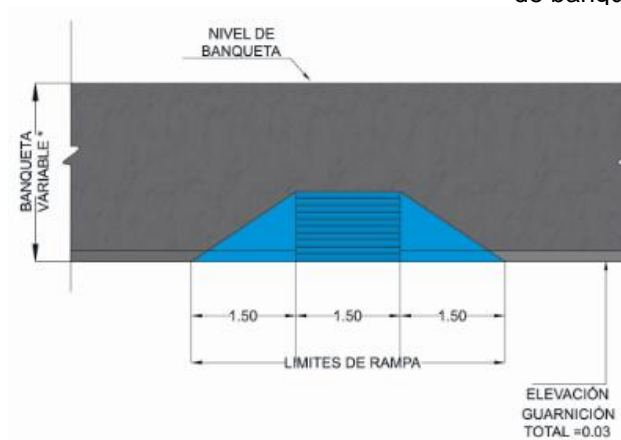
Banqueta en planta NOTA: el ancho de banqueta varía de acuerdo a clasificación de vialidades.
